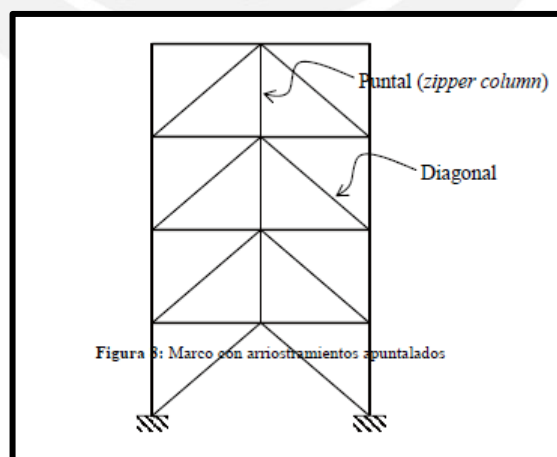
Vista en elevación de un pórtico con columna zipper
